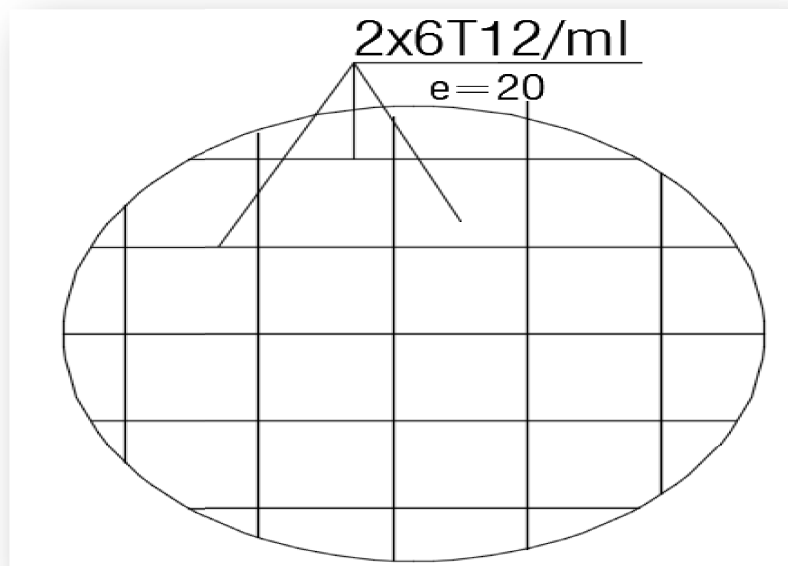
Ferrailage de la dalle pleine en travée et en appuis.
